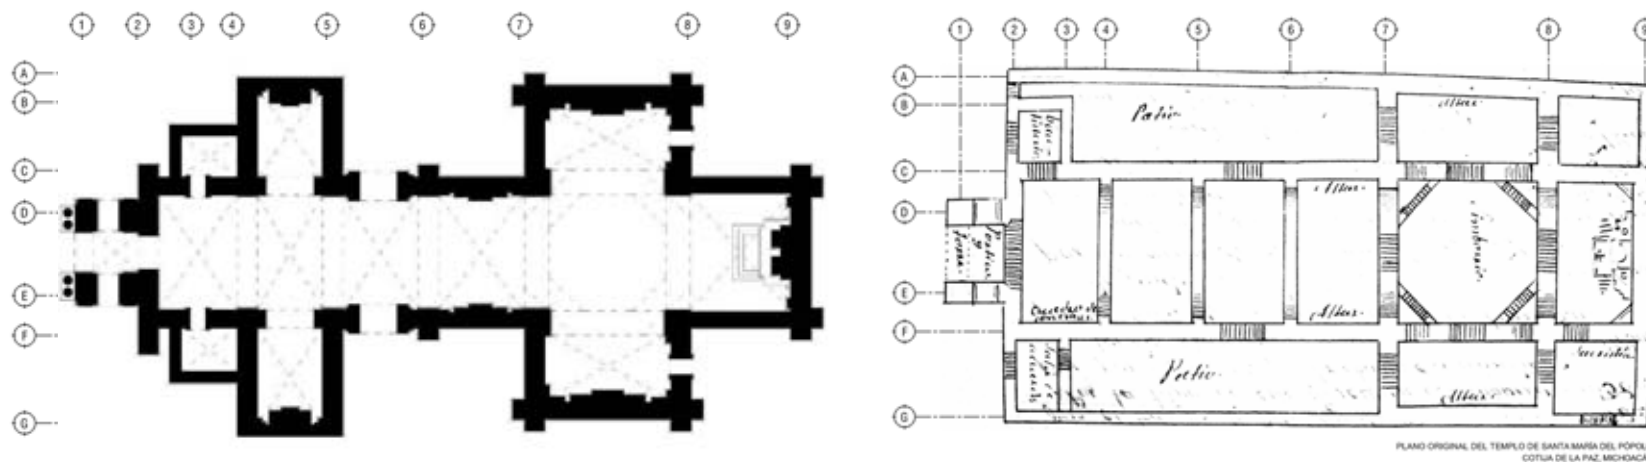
y 32. Superposición del levantamiento arquitectónico (con ejes adicionales) sobre la planta (con los mismos ejes adicionales) dibujada por José María Llerena del Templo de Santa María del Pópulo. Archivo Casa Morelos
